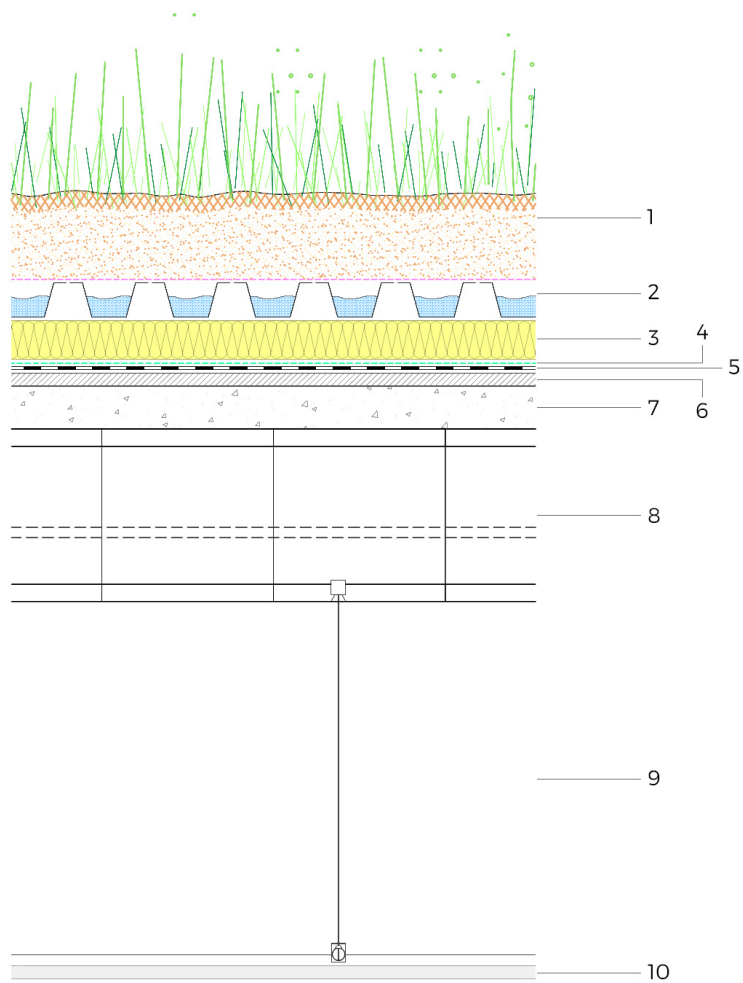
Detalle constructivo de cubierta del modelo B tras rehabilitación.
